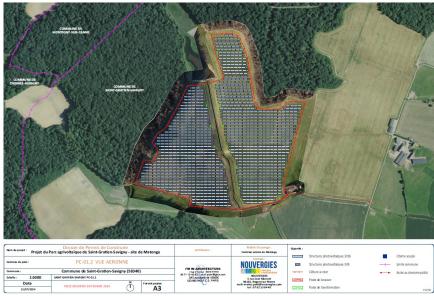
Plan de masse du projet de Matonge (source : dossier de permis de construire)
